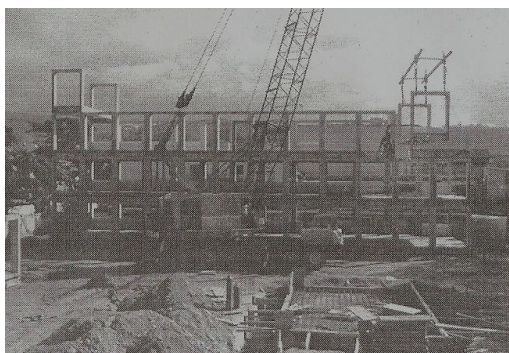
Montaje de la Estructura. Fuente: FEDE.
